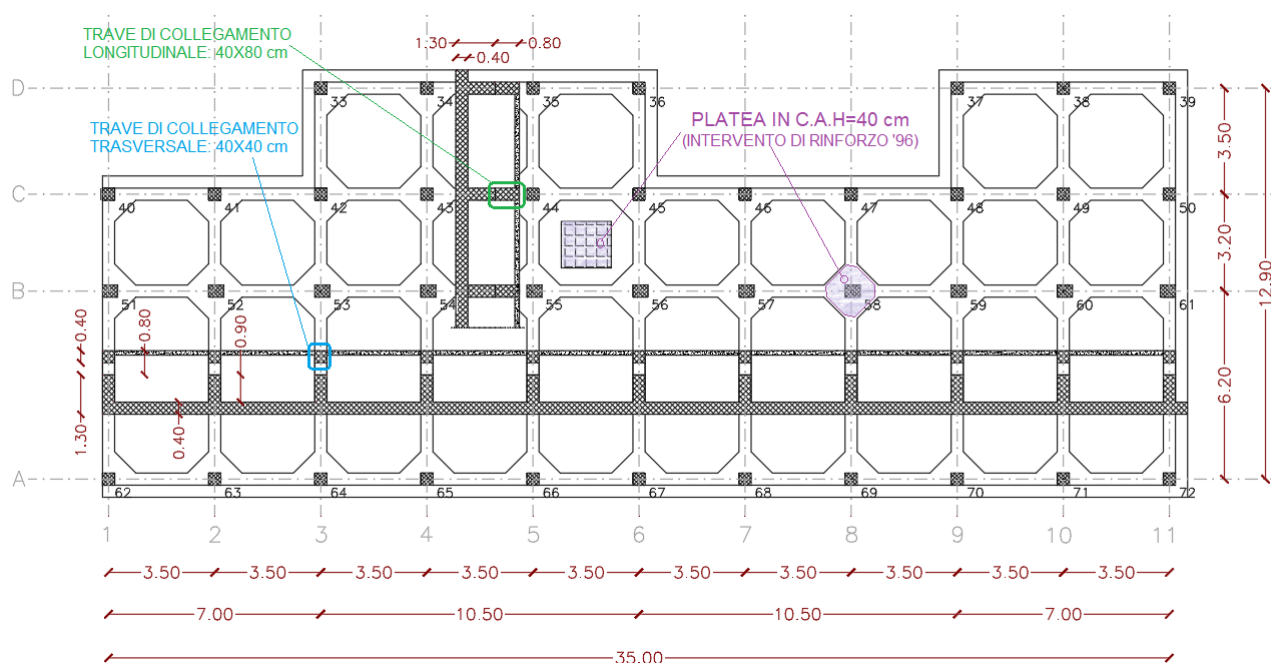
STATO DI FATTO: STRALCIO DELLA PIANTA DI FONDAZIONE DEL BLOCCO B
